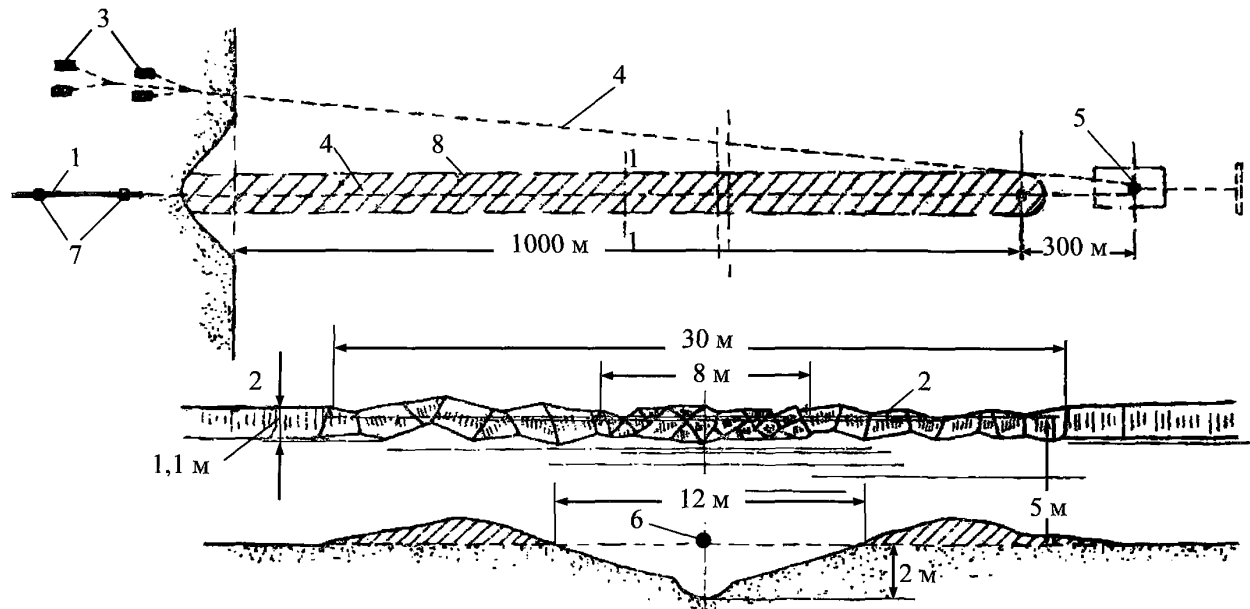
Схема организации работ по прокладке трубопровода в траншею, разработанную взрывом порохового заряда:
